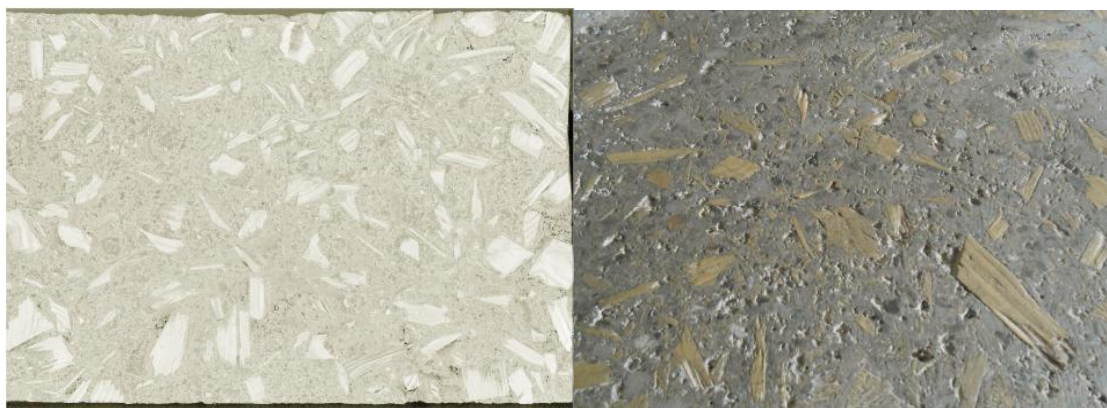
y 164 Texturas ofrecidas por el hormigón con madera, pulido.
